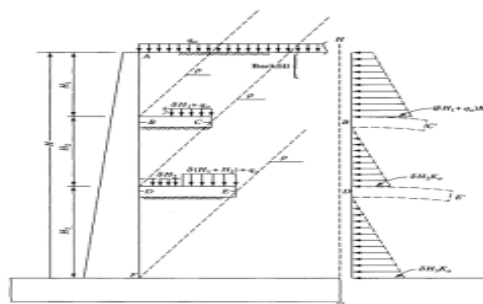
Mur de soutènement en porte-à-faux avec consoles de soulagement
